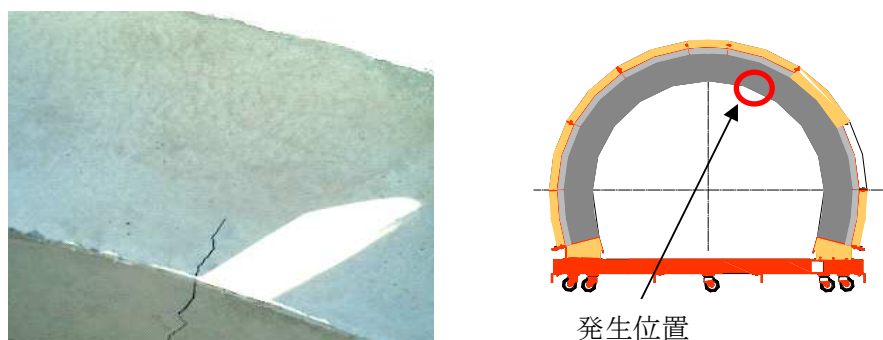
ひび割れ発生状況 (標準ケース (Case1)、天端～肩部の間)
